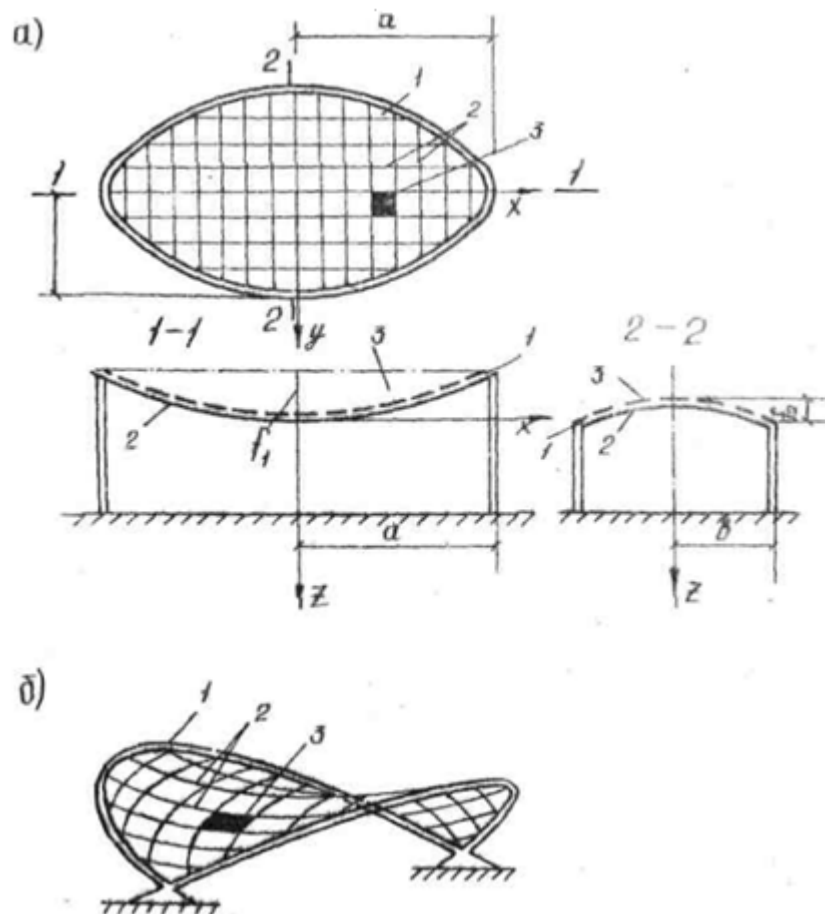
Схемы вантовых покрытий с перекрестным расположением вант:
